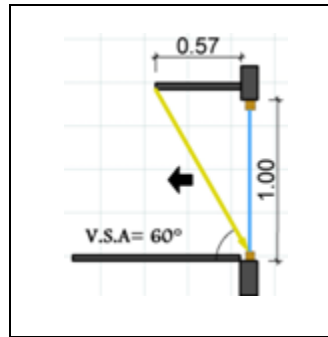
Profondeur requise d'un auvent d'une façade sud
